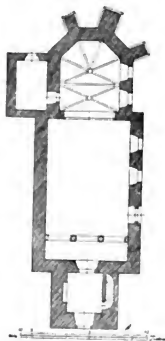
Gross-Petschitz. Grundriss der Kirche.
